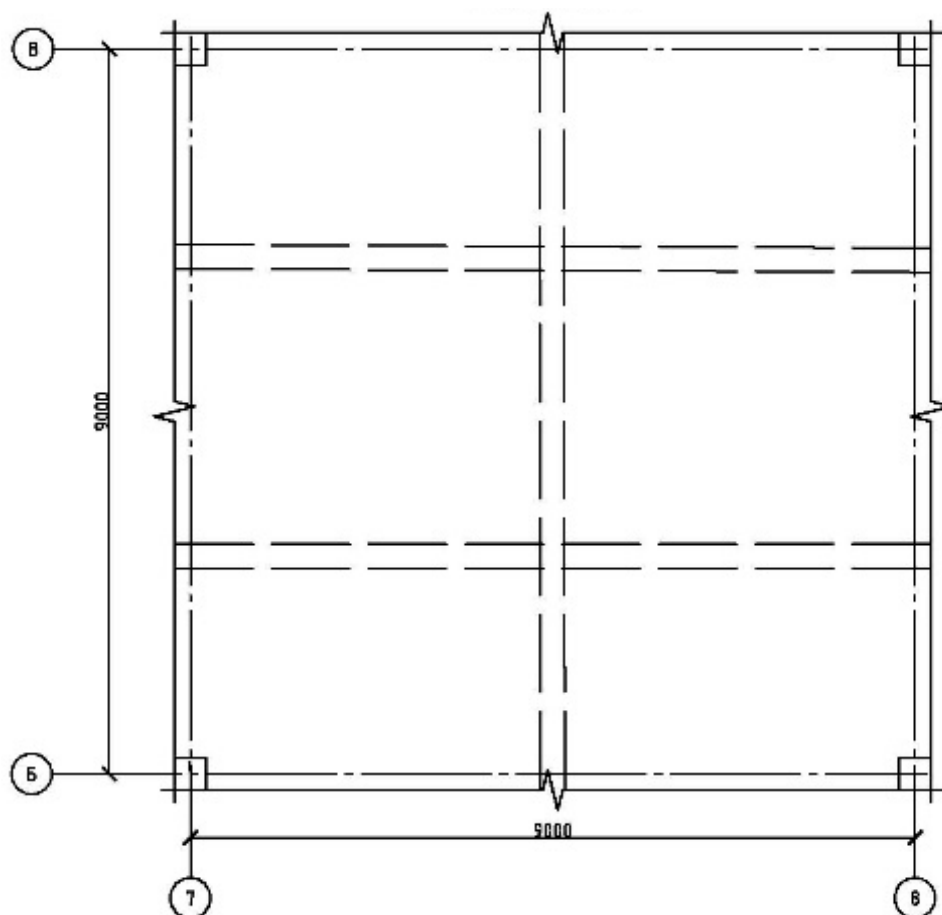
Схема перекрытия на отметке + 4,300
